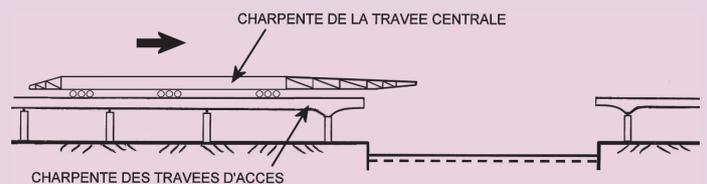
Principe du lançage sur tronçons de charpente déjà en place
